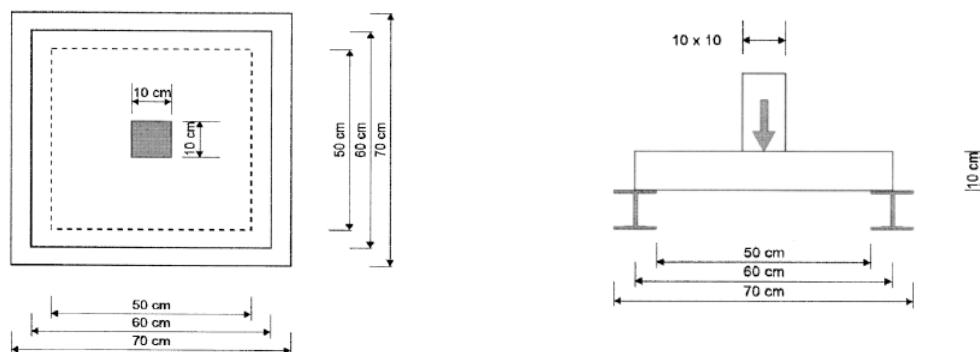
Vista en planta de los paneles fabricados. Figura 12. Apoyo de paneles y tipo de carga aplicado.
